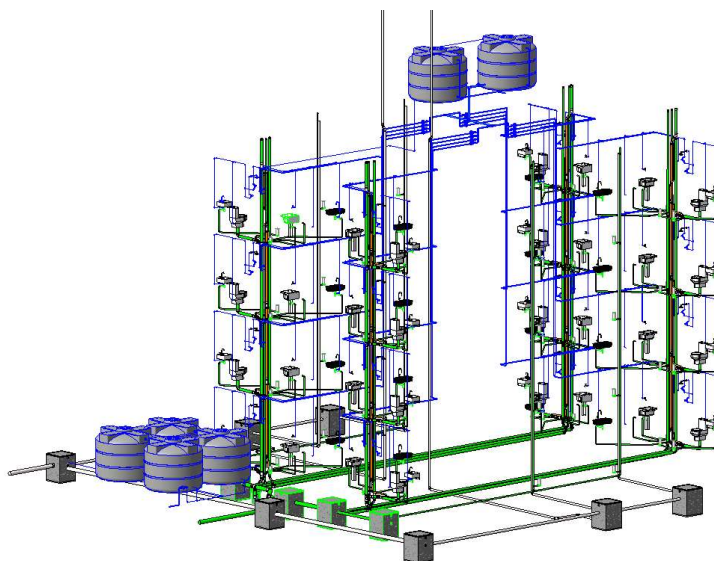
Vista 3D das instalações hidrossanitárias do apartamento tipo
